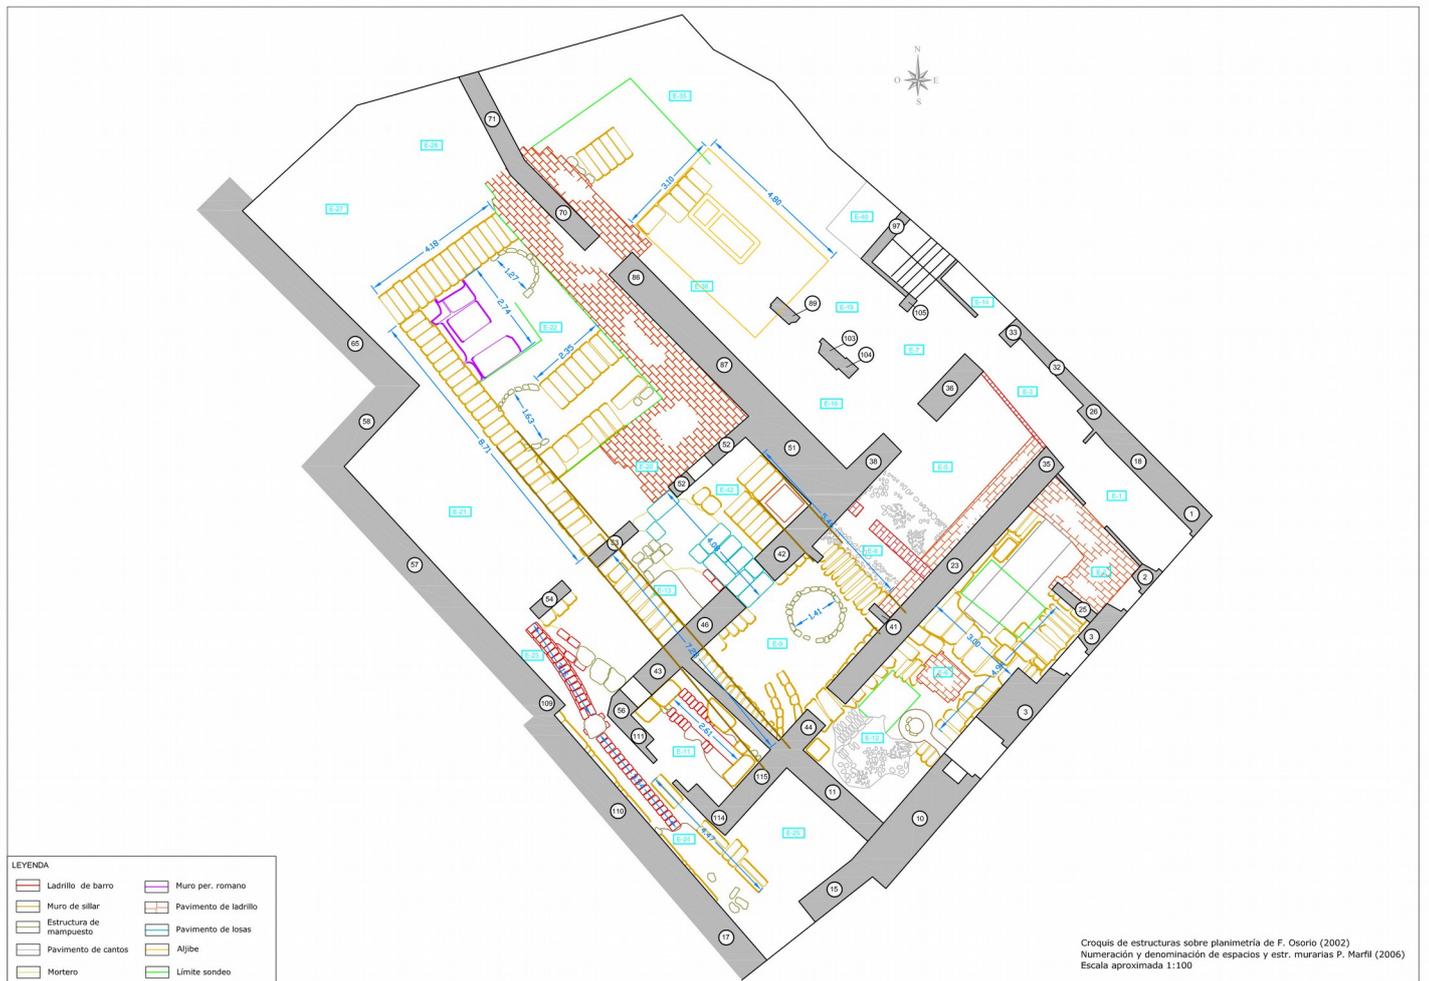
Croquizado General de las estructuras del Baño de la Pescadería o de la calle Cara.
